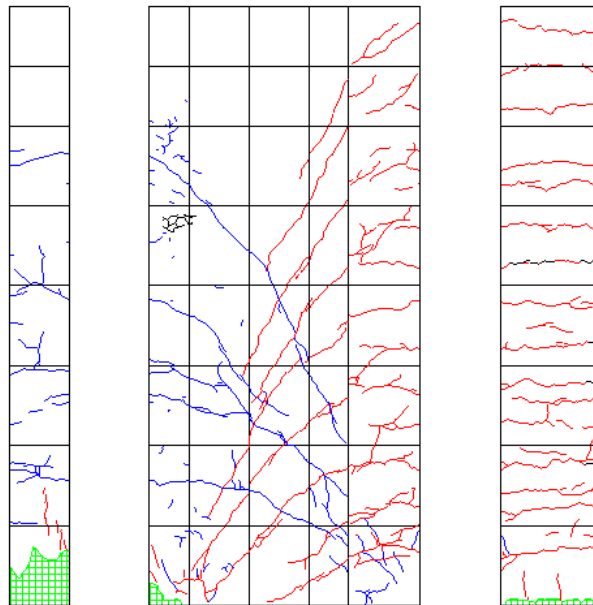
R=-1/33 ひび割れ図
